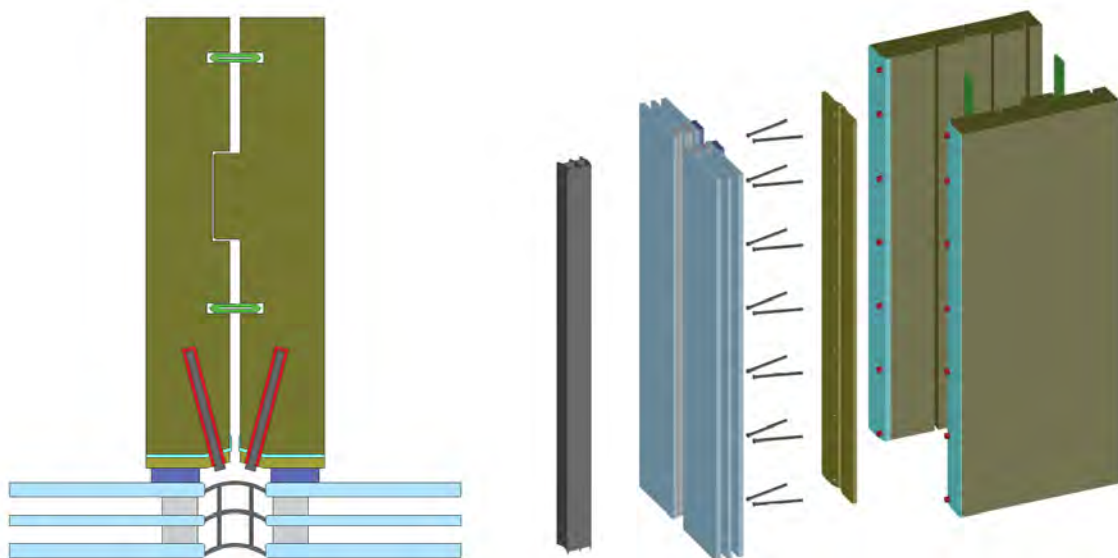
Holz-Glas-Verbindungen (Horizontalschnitt und Explosionszeichnung)
